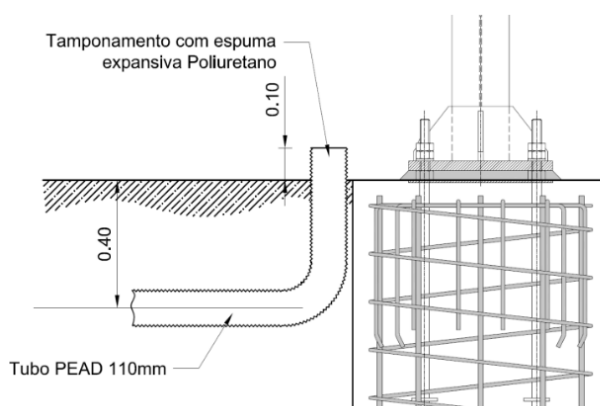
Tubo PEAD 110 mm para passagem de cabos de energia entre o poste e a caixa de inspeção
